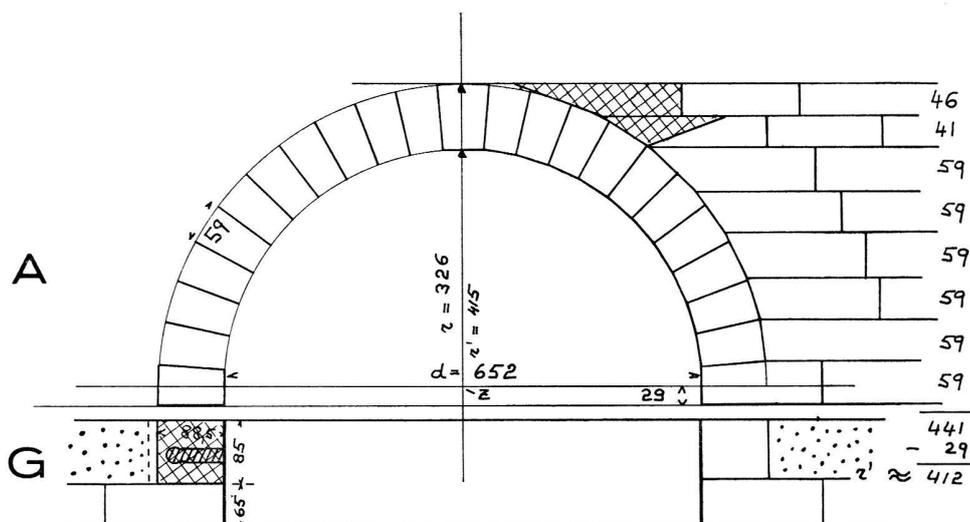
Avenches VD, Osttor. Rekonstruktion des Torgewölbes. A Aufriß, G Grundriß. Die 1941 ins Museum zurückgeführten Blöcke sind doppelt schraffiert, das auf Tafel 12, 1 sichtbare Gußmauerwerk ist im Grundriß punktiert. Der Block links im Grundriß mit der Ausparung für die Torangel greift unter das anstoßende Mauerwerk hinunter (gestrichelte Linie). Man beachte die Regelmäßigkeit der Anlage: die 23 Gewölbesteine haben alle dieselben Dimensionen mit Ausnahme des Mittelstückes. Die zwei obersten Quaderlagen sind weniger dick, damit die Scheitelhöhe des Gewölbes nicht überschritten wird. - 1:100.
